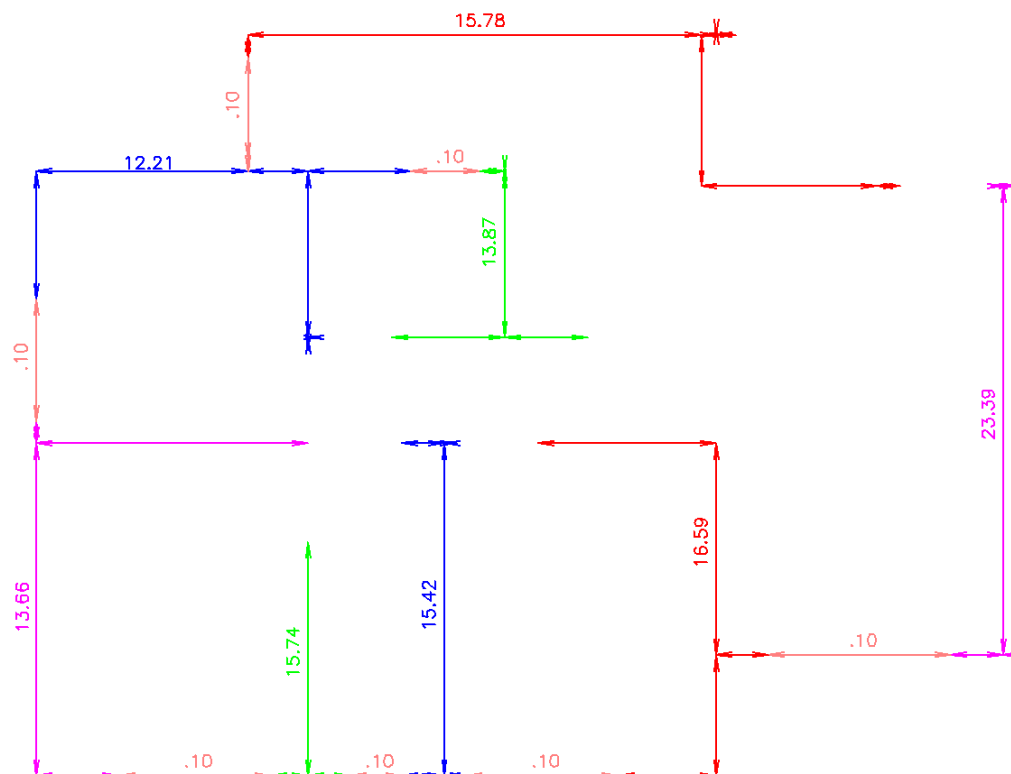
Intensidade (kN/m) das cargas verticais uniformemente distribuídas aplicadas no topo de cada pavimento do Caso I.
